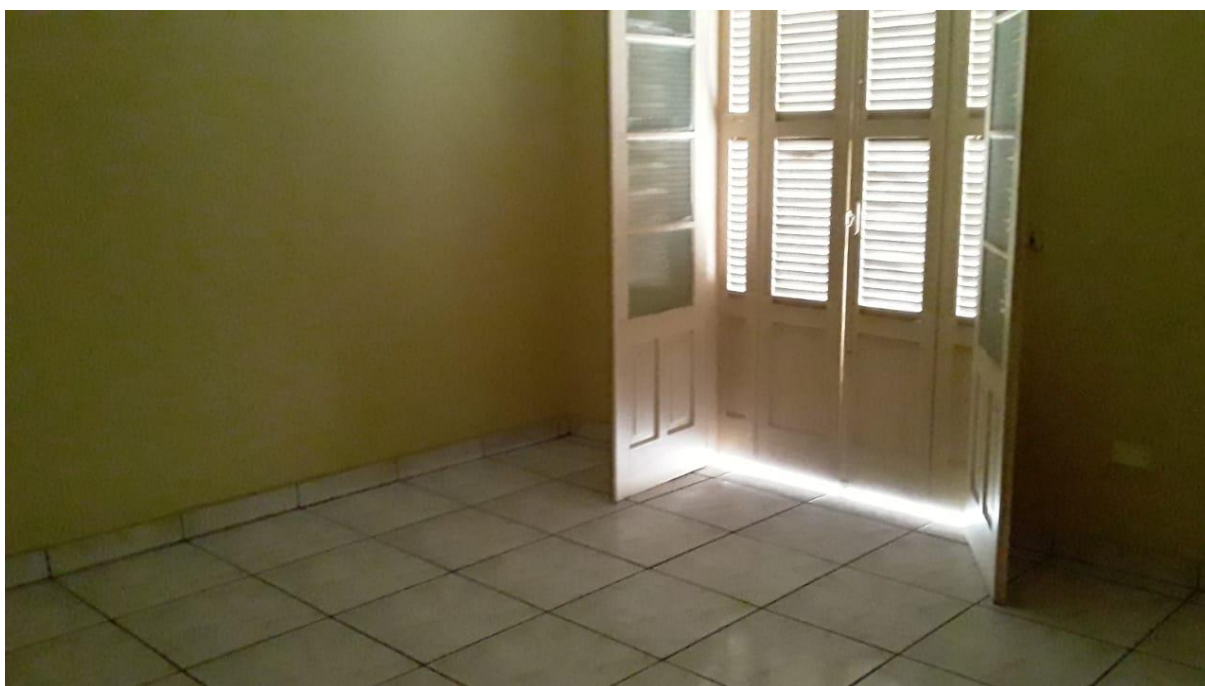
Vista do dormitório 2 do imóvel similar.
